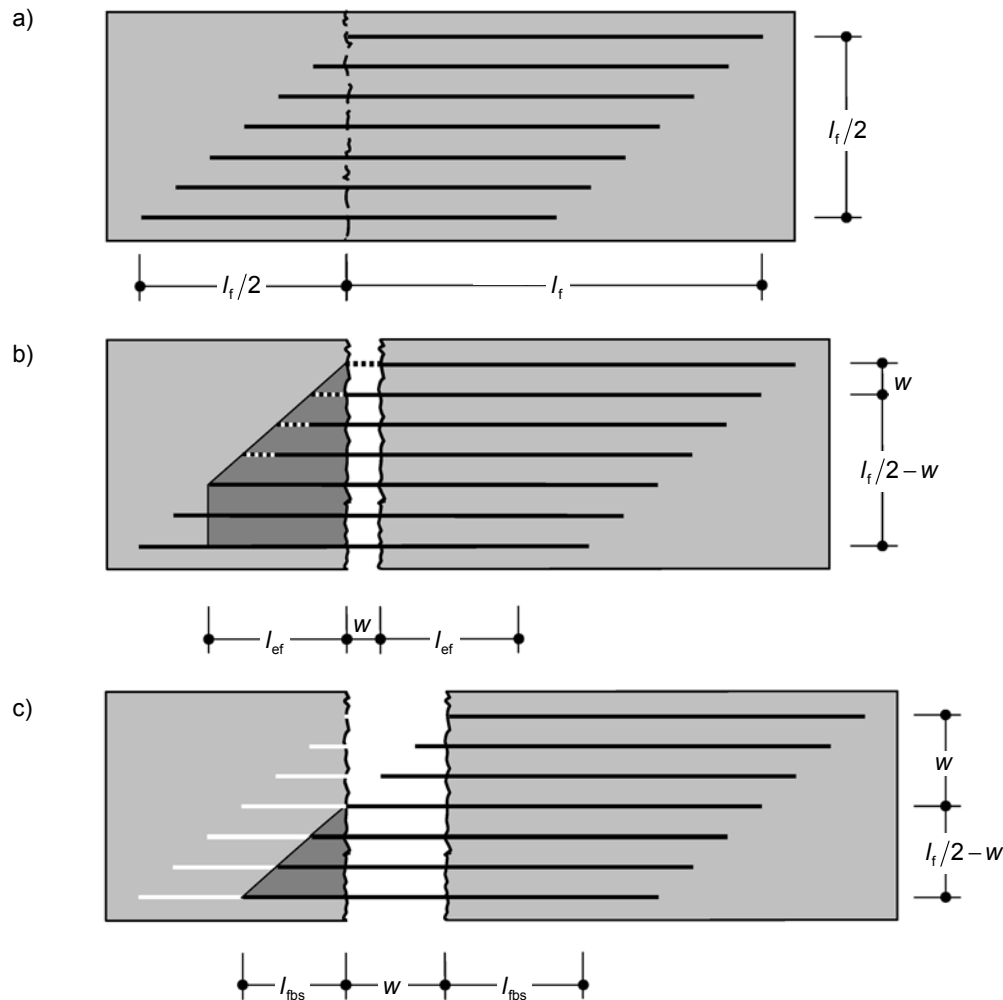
Faserbeton mit parallelen, in Zugrichtung orientierten Fasern [Jun06]
